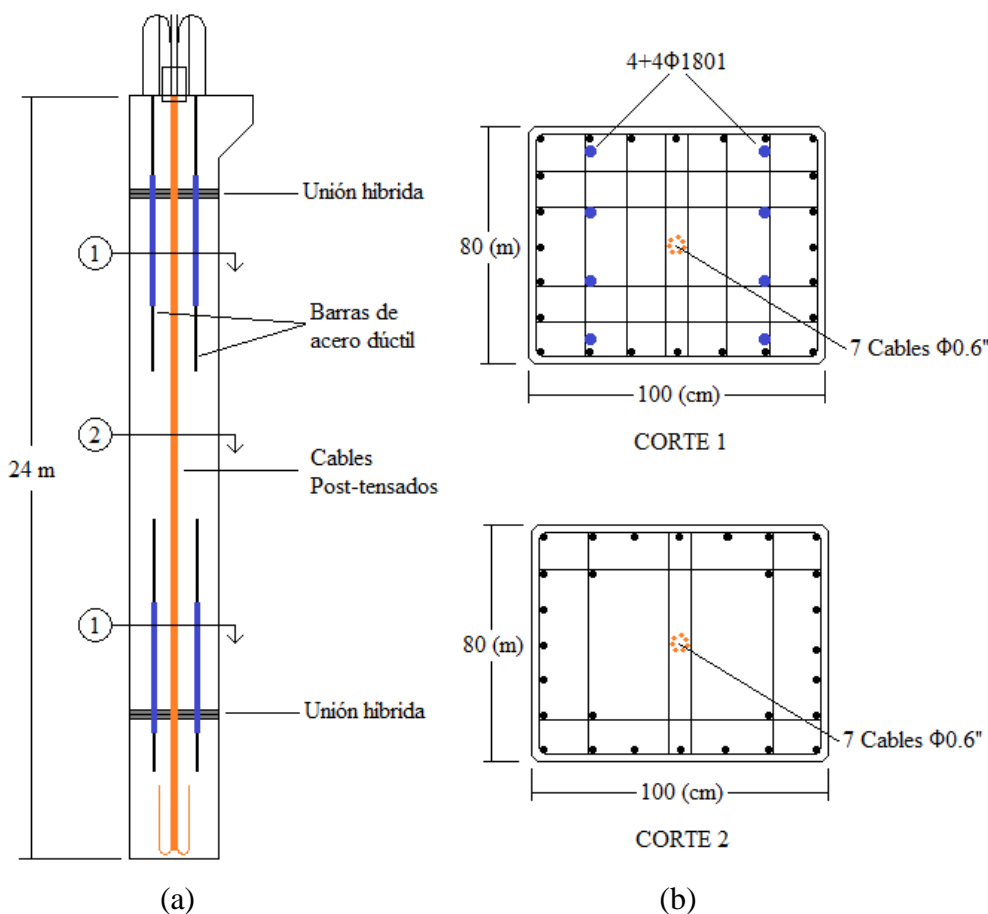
Detalles constructivos, (a) columna y componentes, (b) cortes y detalles transversales (adaptadas de planos constructivos CITEC UBB)
